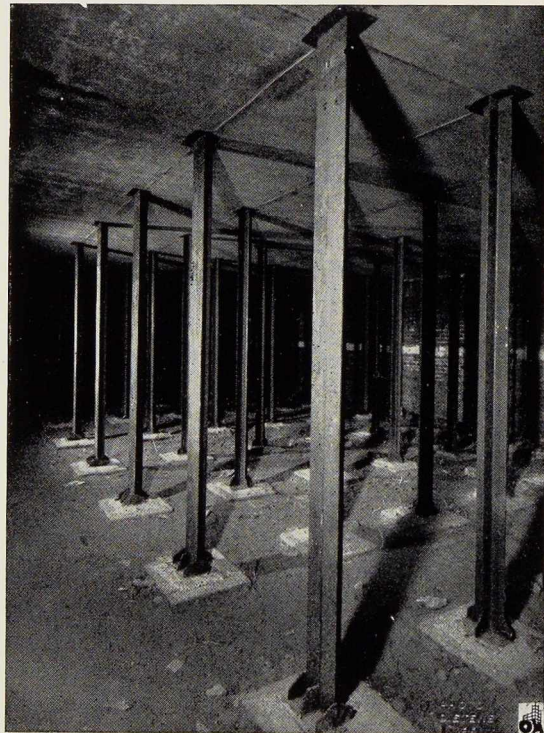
Poteaux métalliques prenant appui sur des semelles en béton.
